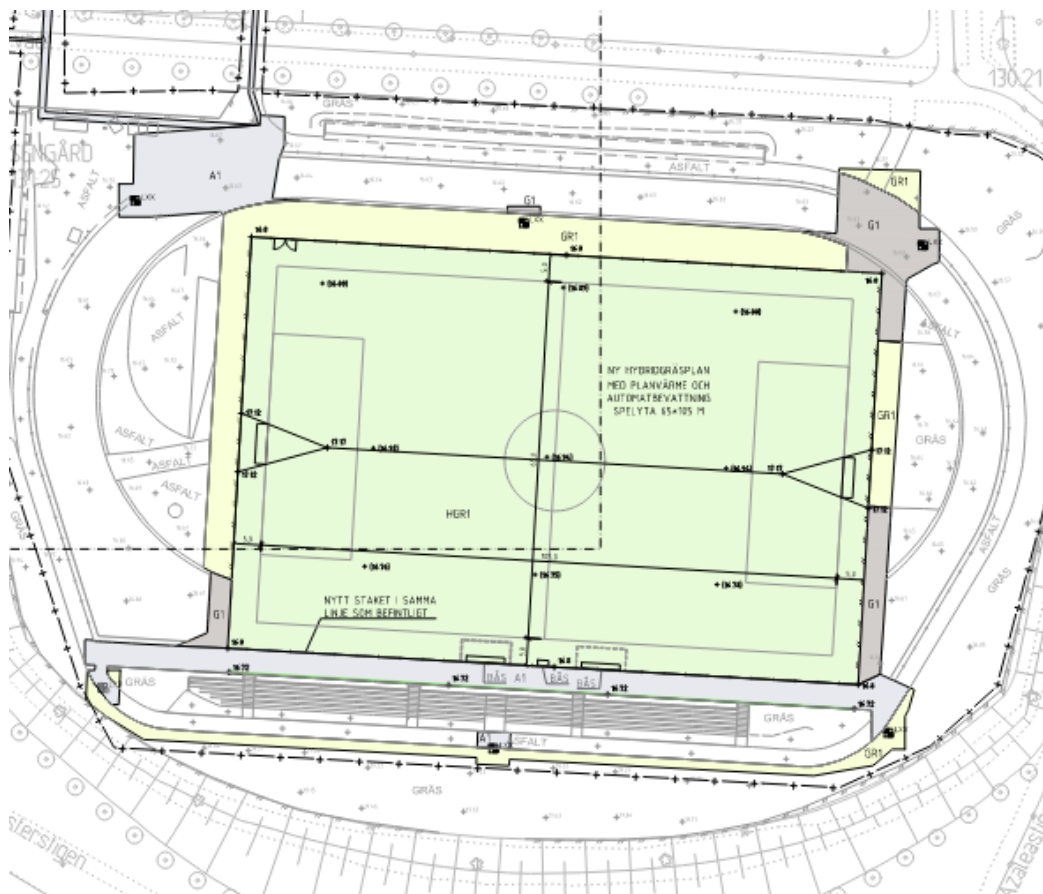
Hybridgräsplan, underliggande visas befintlig gräsplan.
